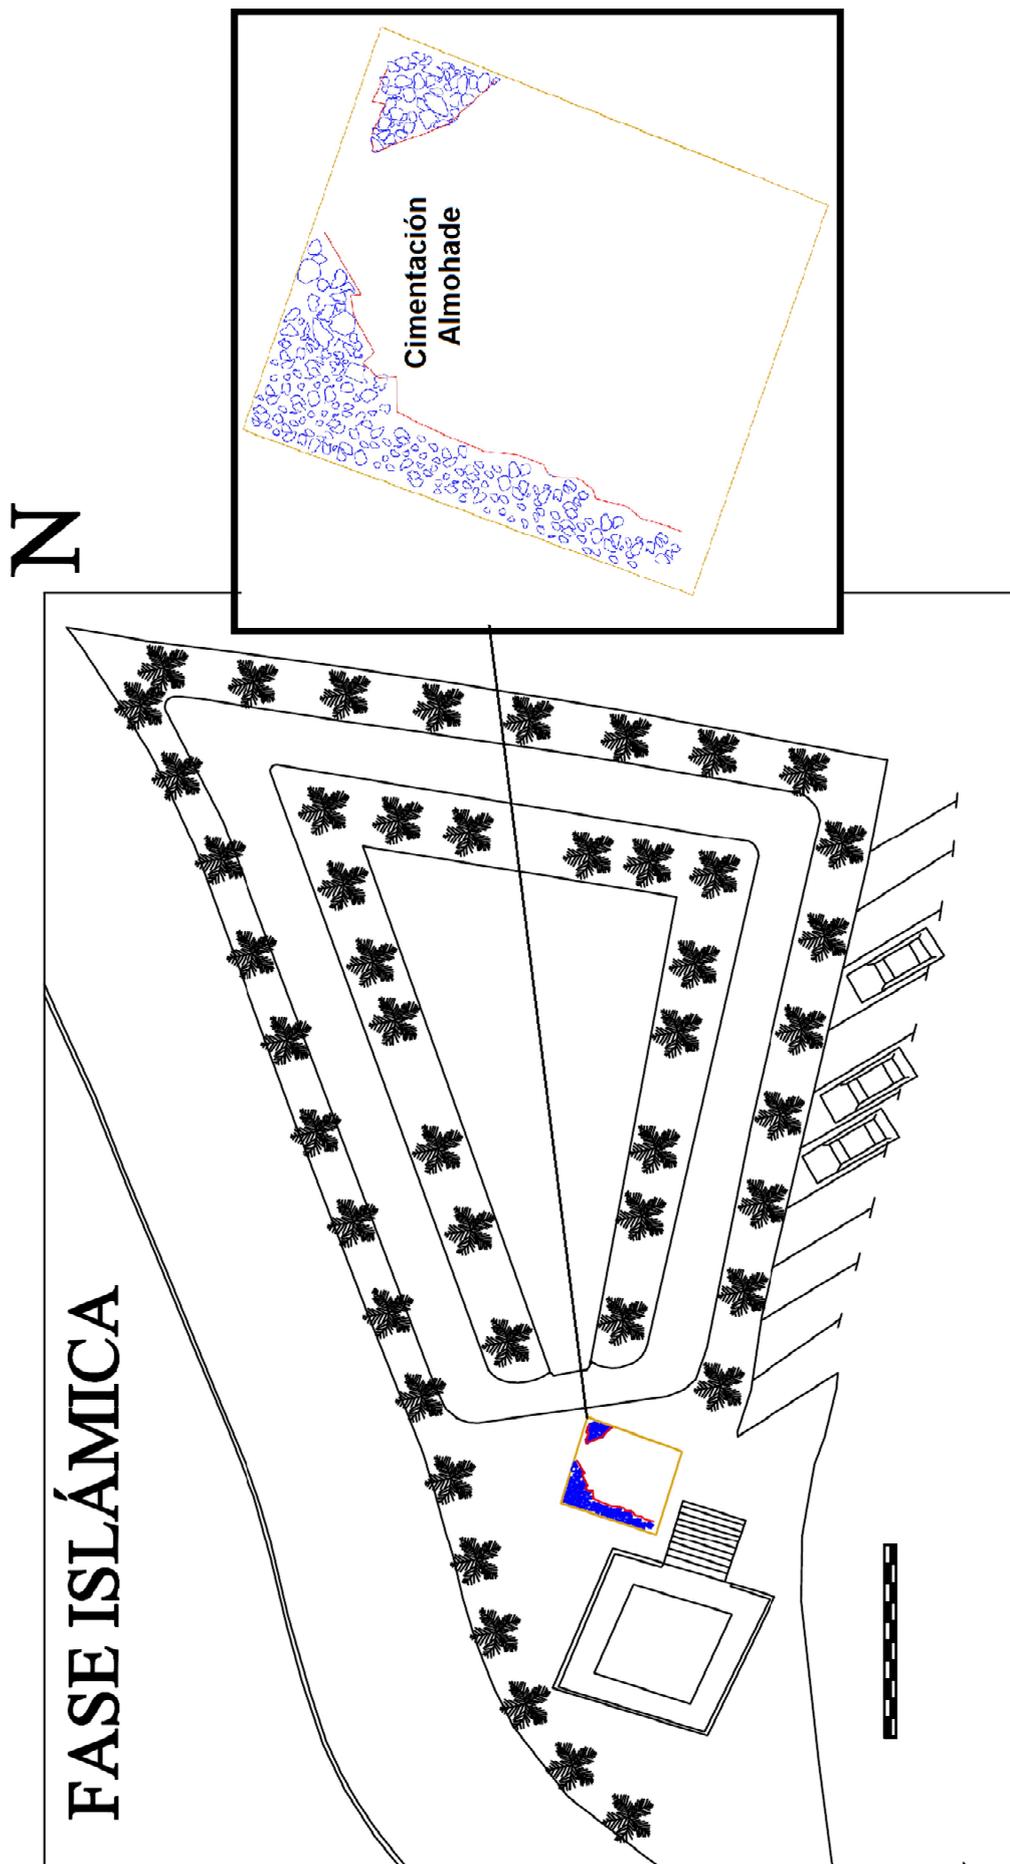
Planimetría de la fase islámica (siglo XII)
